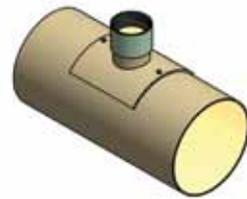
Aufsetzen des Sattelstückes und Einbringen der Verschraubung
